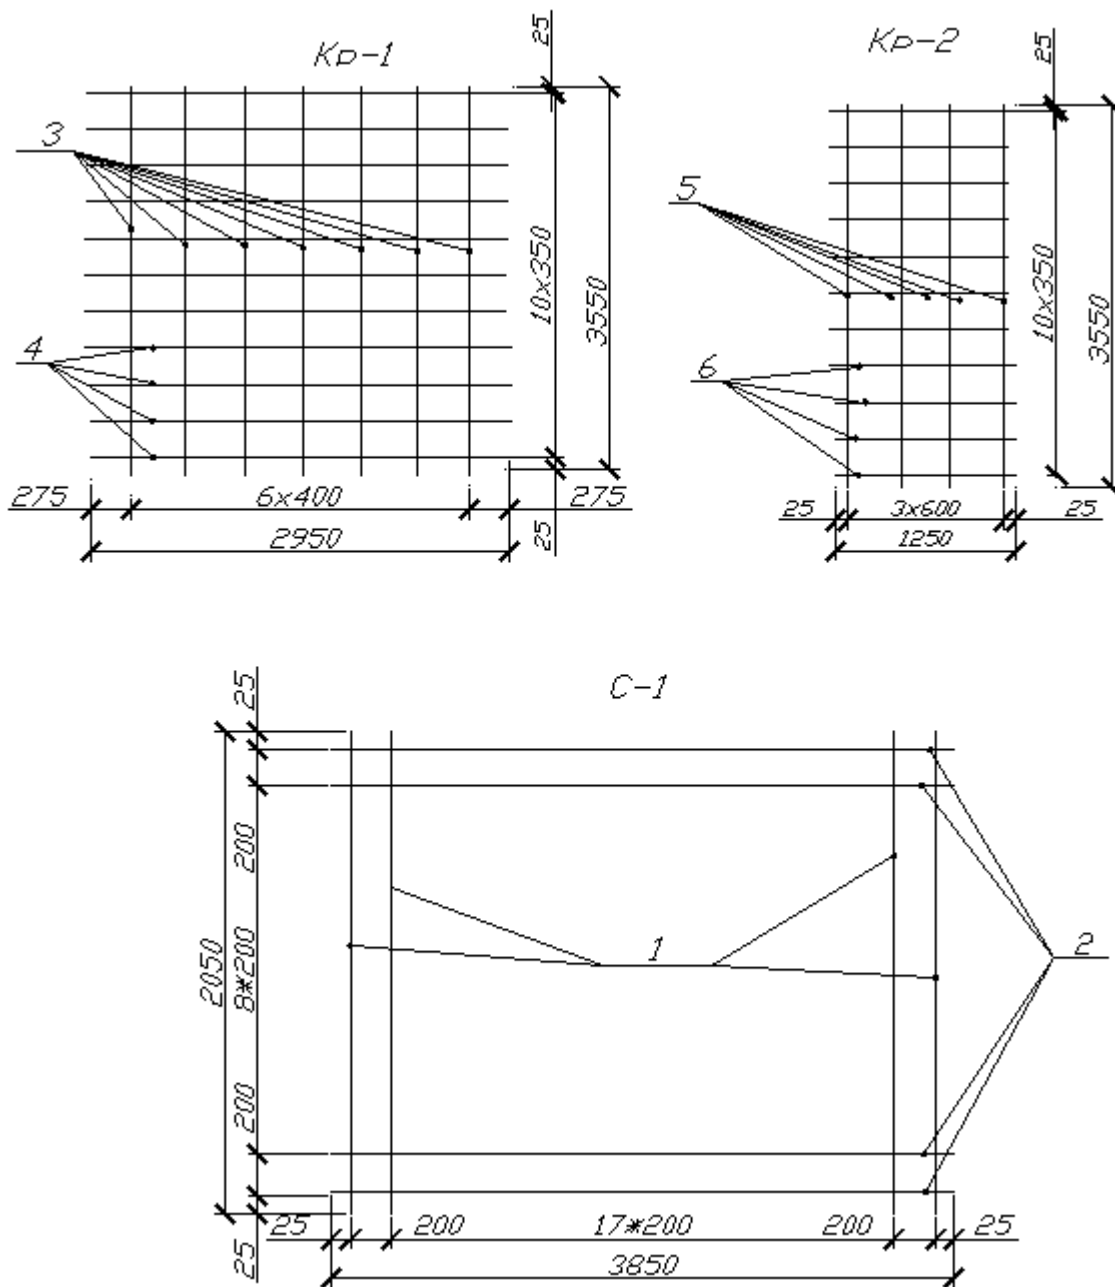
Схеми армування фундаменту сітками і каркасами
